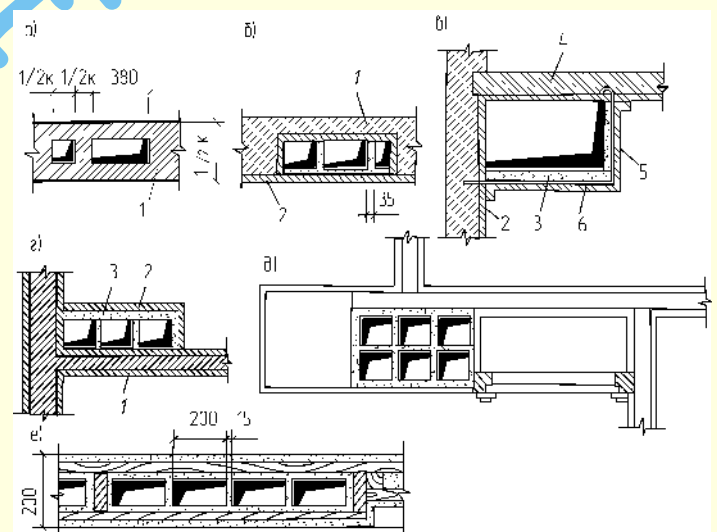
Конструкция вентиляционных каналов и воздуховодов:
